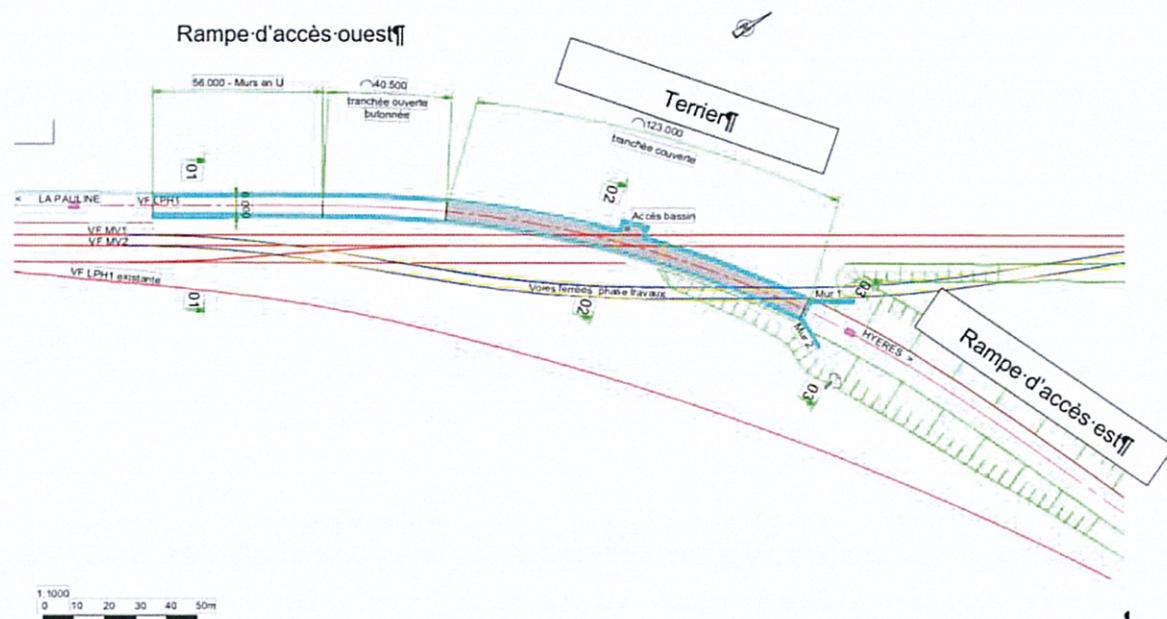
Vue en plan du terrier et des rampes d'accès (source : Etudes Préliminaires, Egis, 2021)
